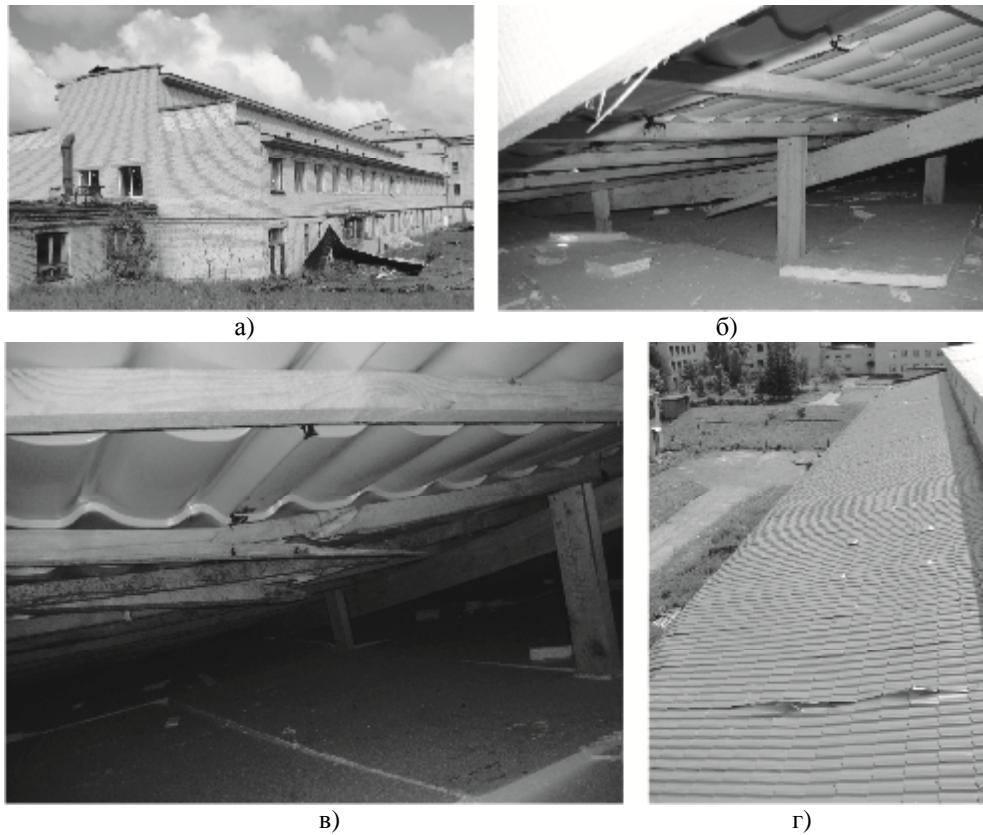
Разрушение конструкций крыши здания (а) после аварии: б – стропил; в – обрешетки; г – кровли
